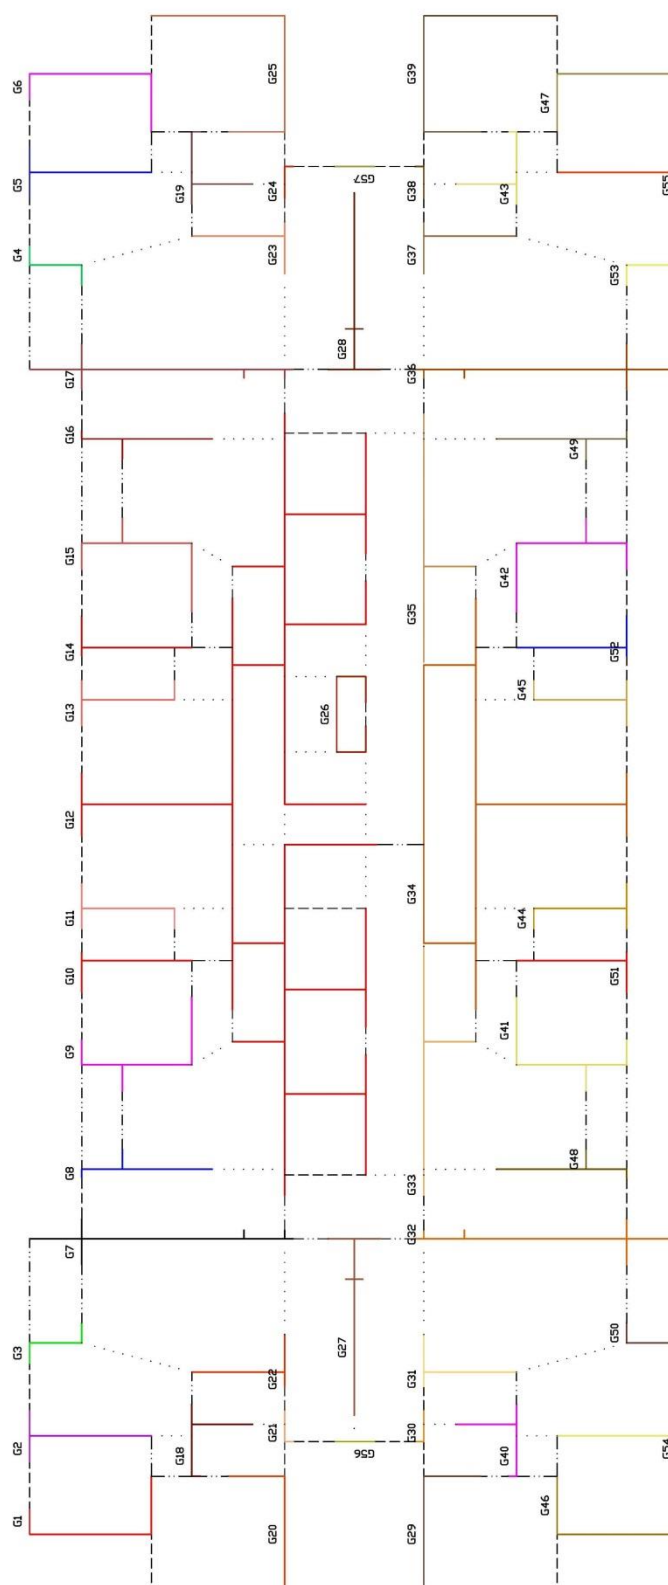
Edifício Vita Belle: grupos de paredes isoladas para ações verticais
